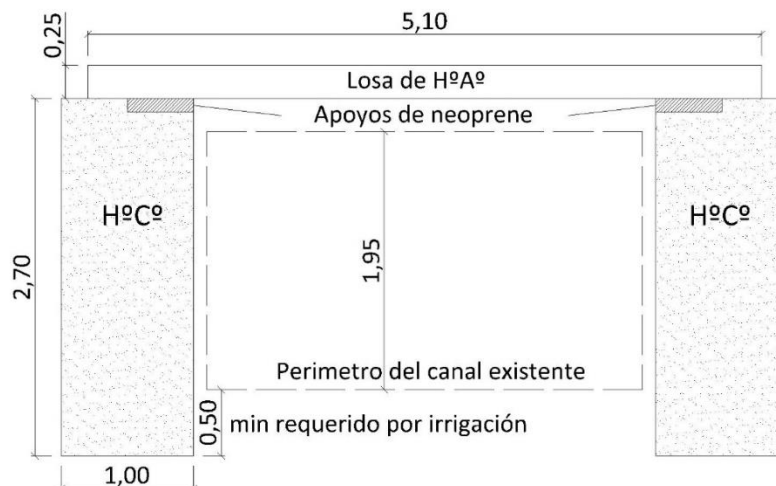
Esquema de estructura de cruce de canal marginal derecho con losa de HºAº simplemente apoyada.
